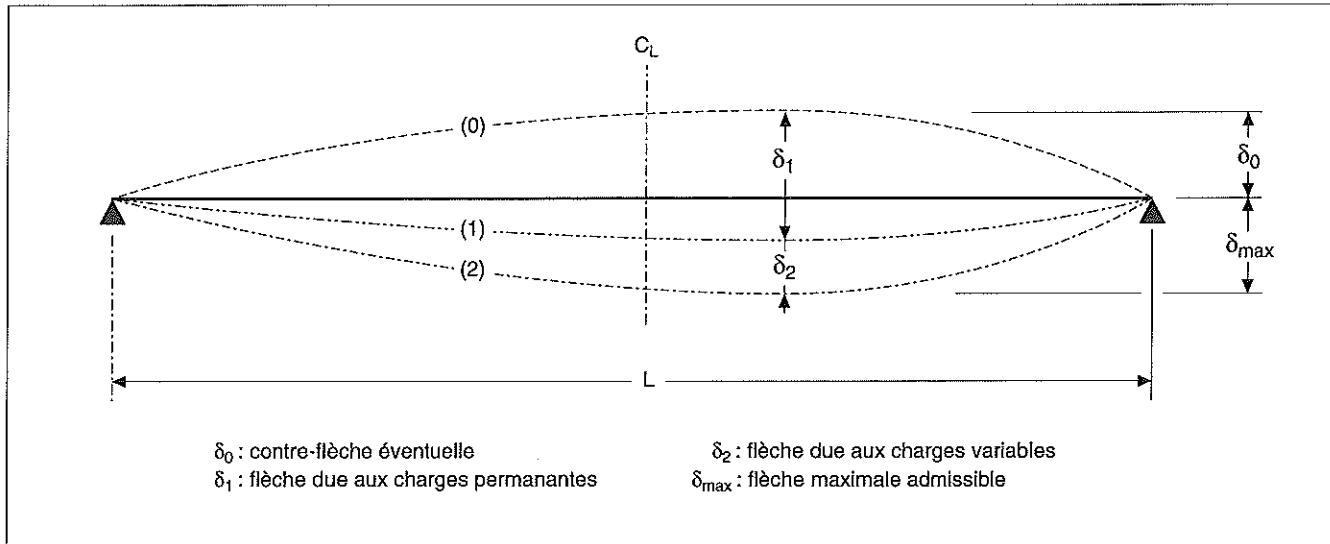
Flèches d'une poutre en acier.
